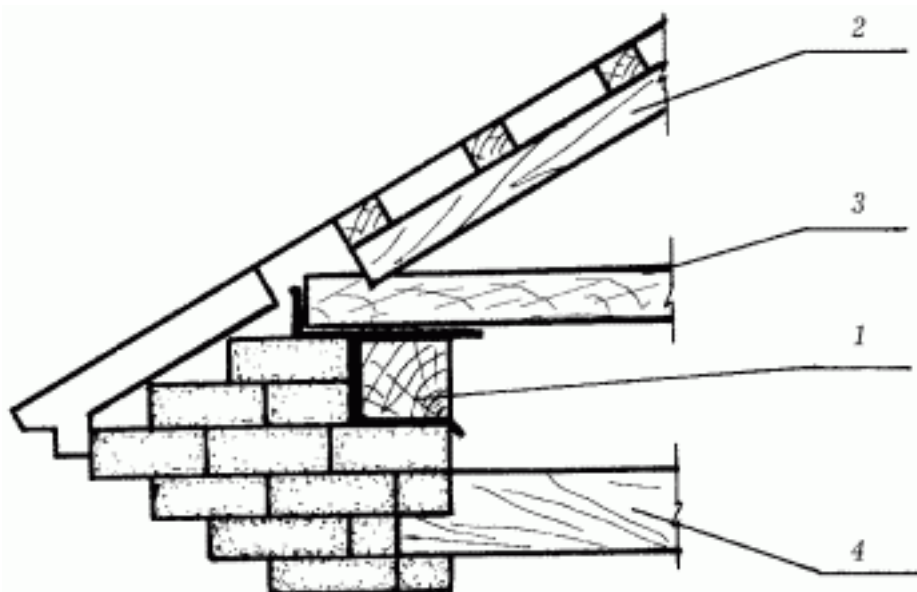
Опора наслонных стропил в каменных зданиях: 1 – мауэрлат; 2 – стропильная нога; 3 – затяжка; 4 – чердачное перекрытие.
